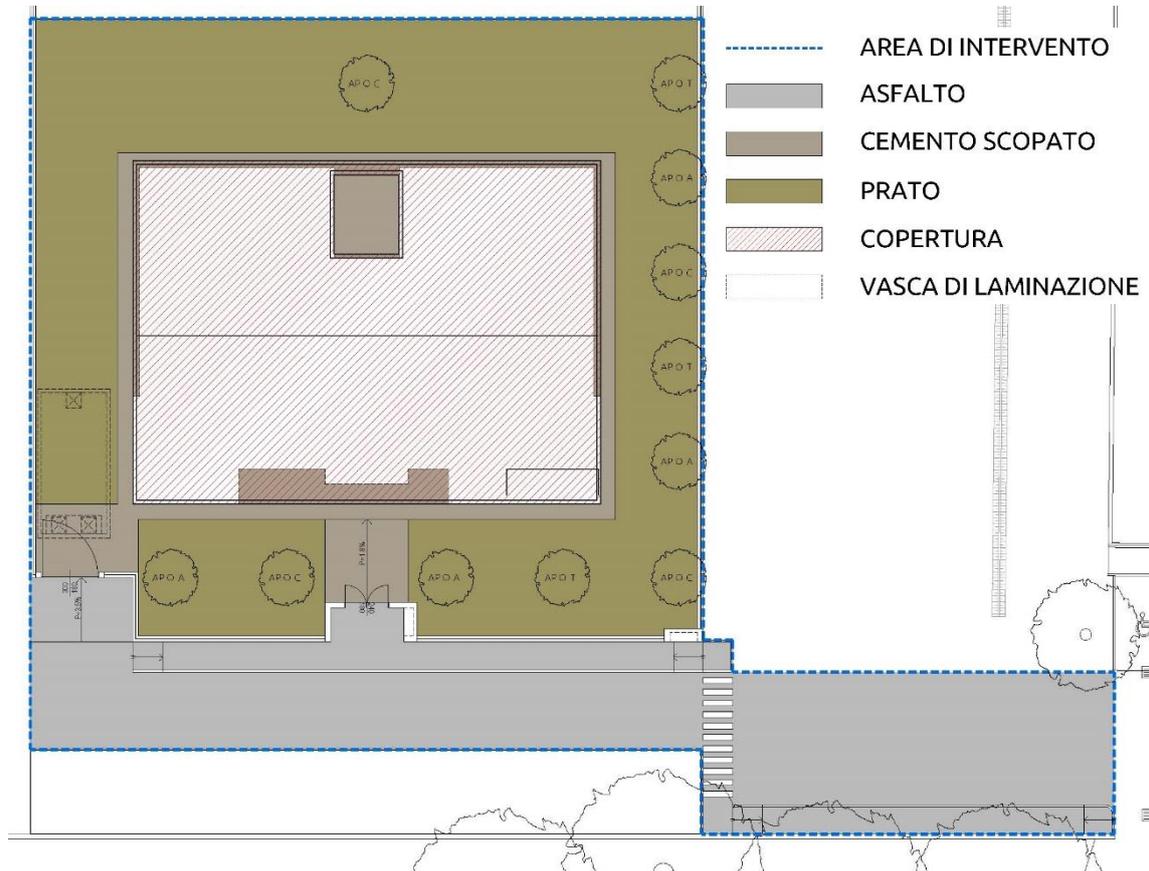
Planimetrie con superfici impermeabili, semipermeabili, drenanti
